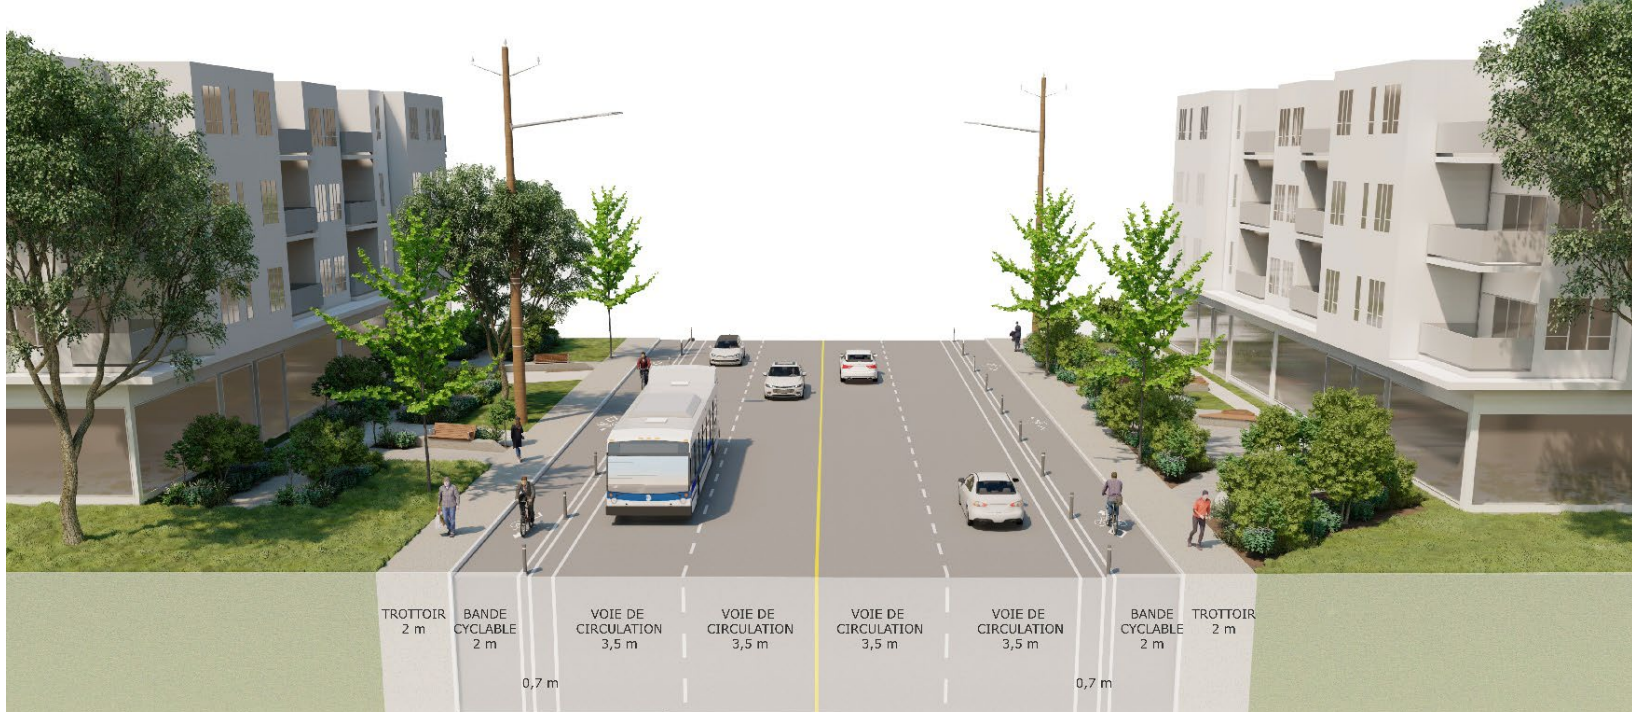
Tronçon sud – Destination mixte – Coupe des propositions conceptuelles 2040
